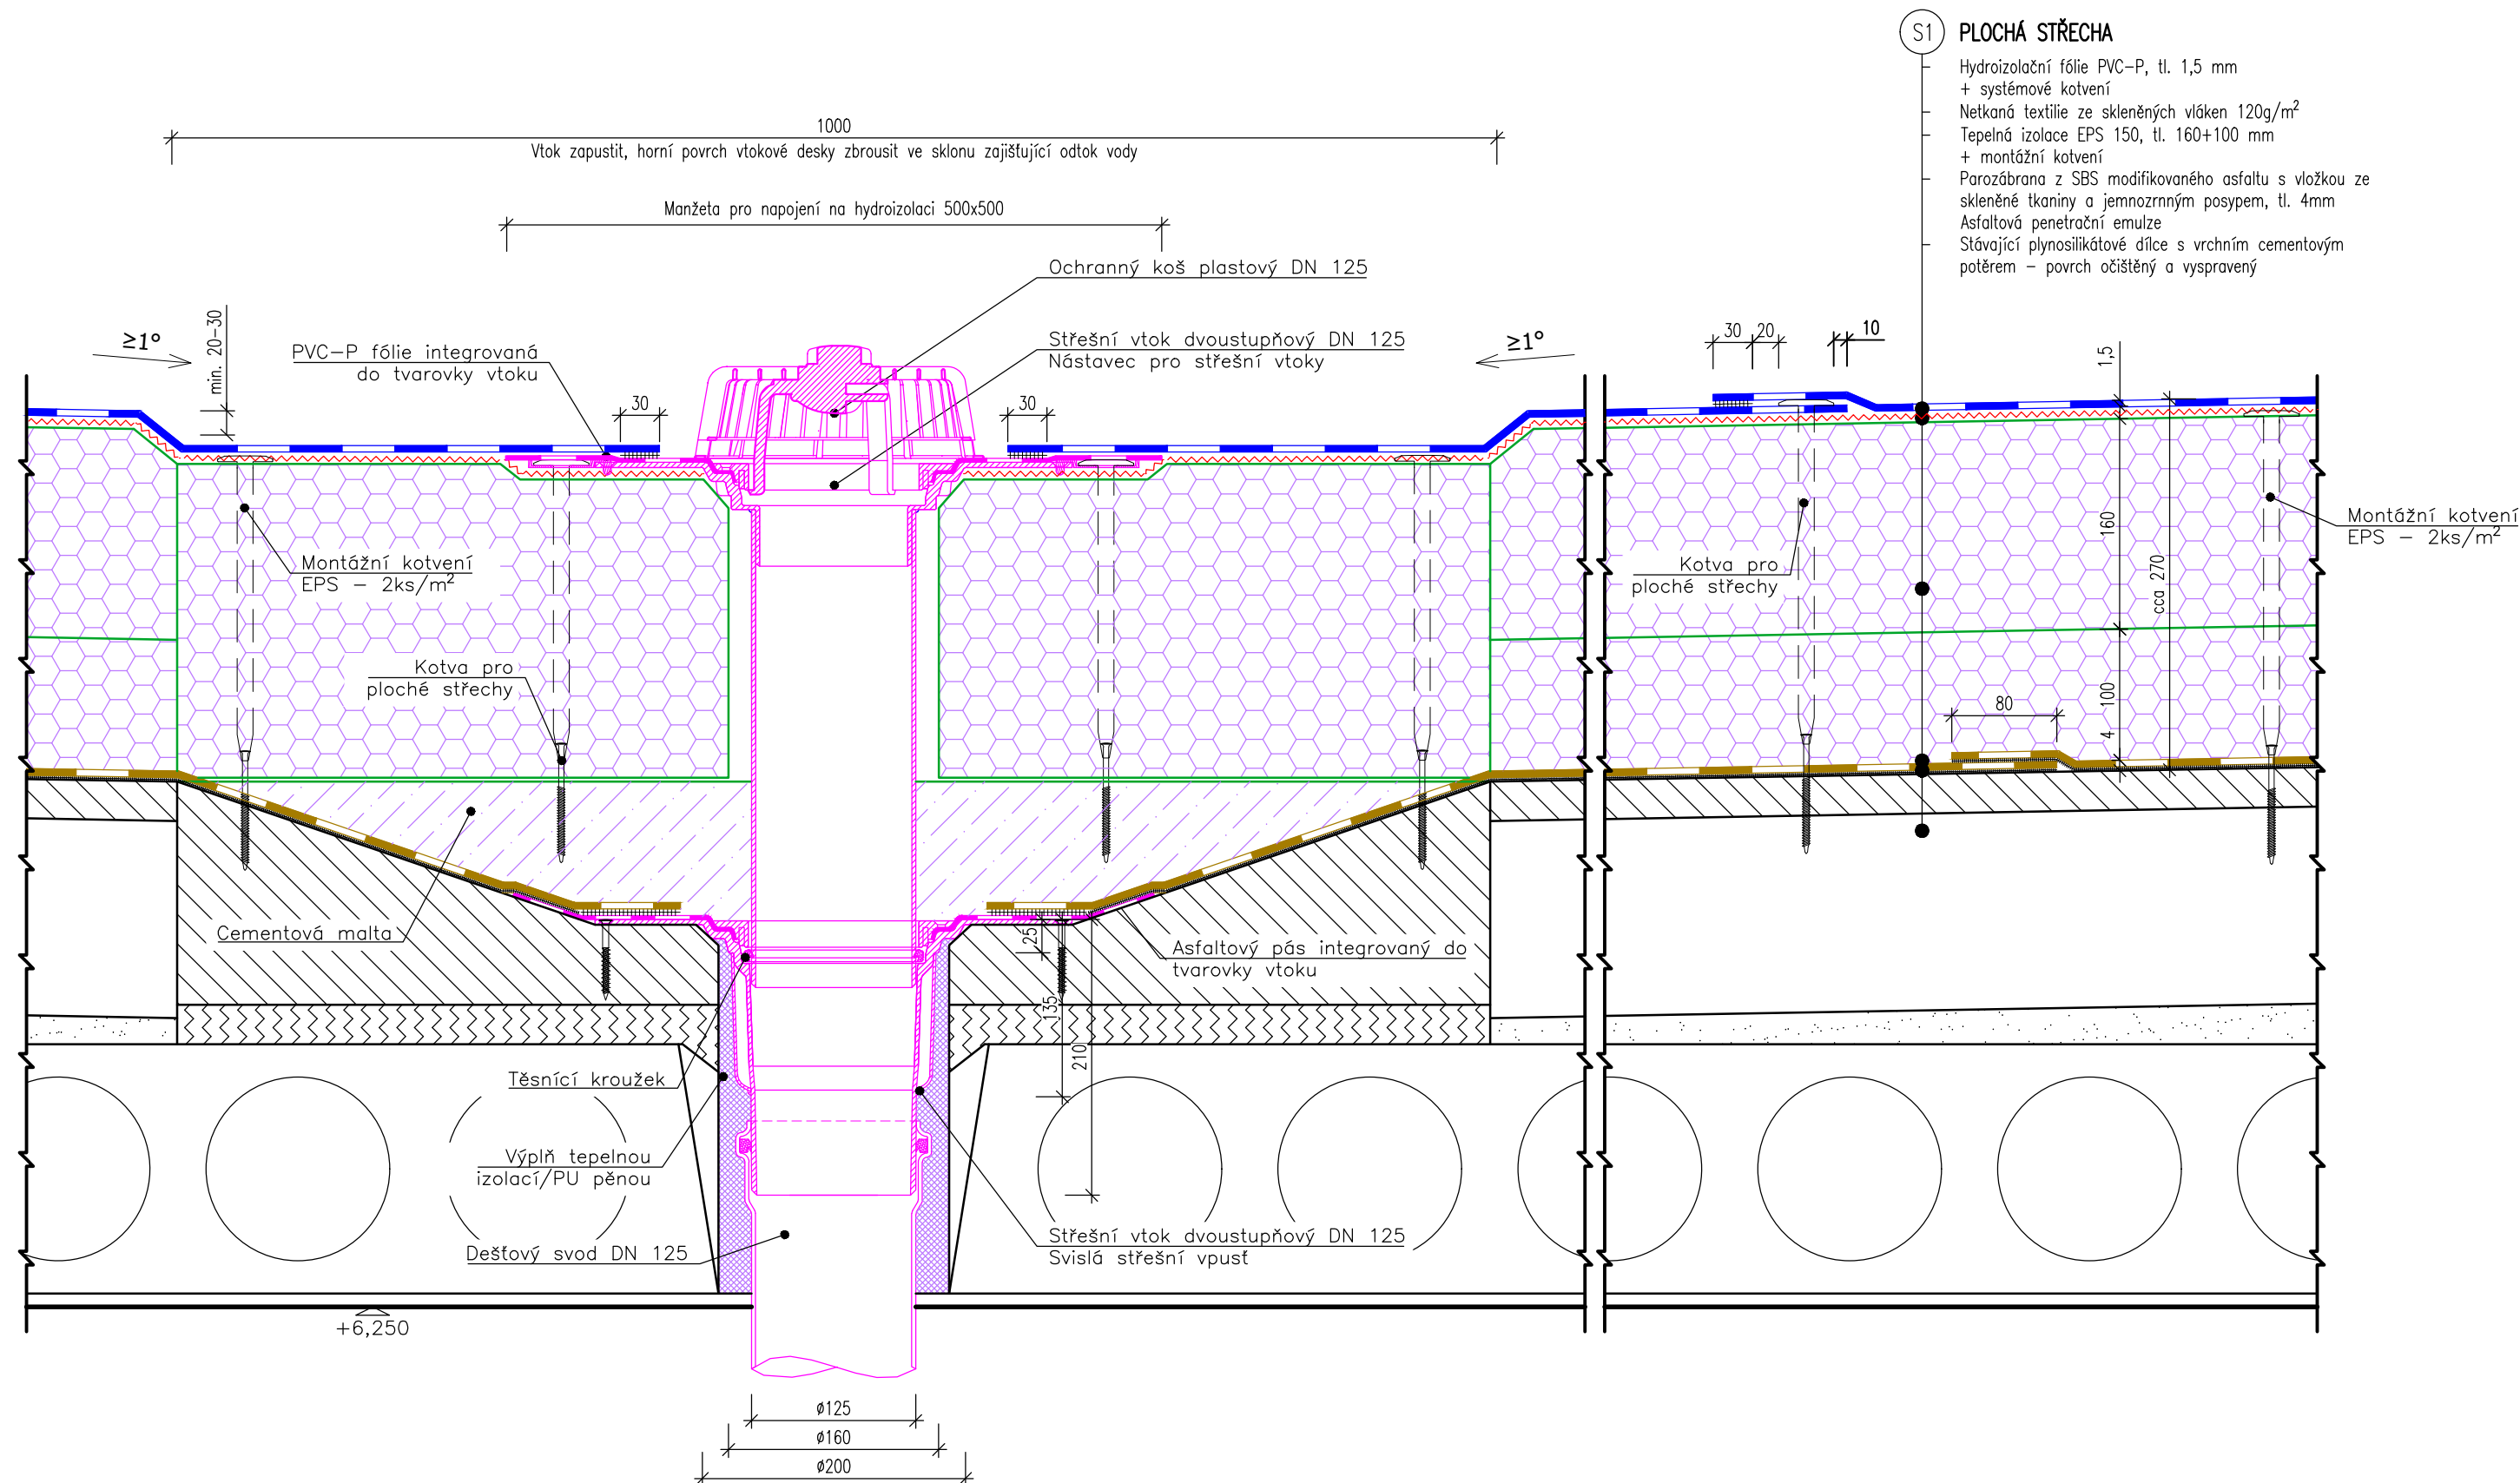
DETAIL STŘEŠNÍ VPUSTI, M1:5
